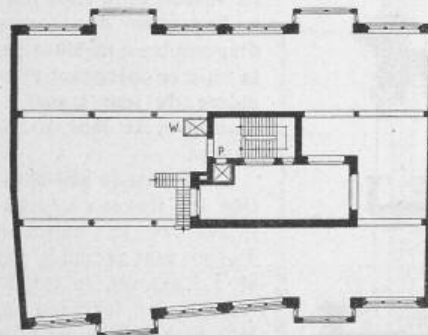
Grundriss vom I. Stock 1:500.
